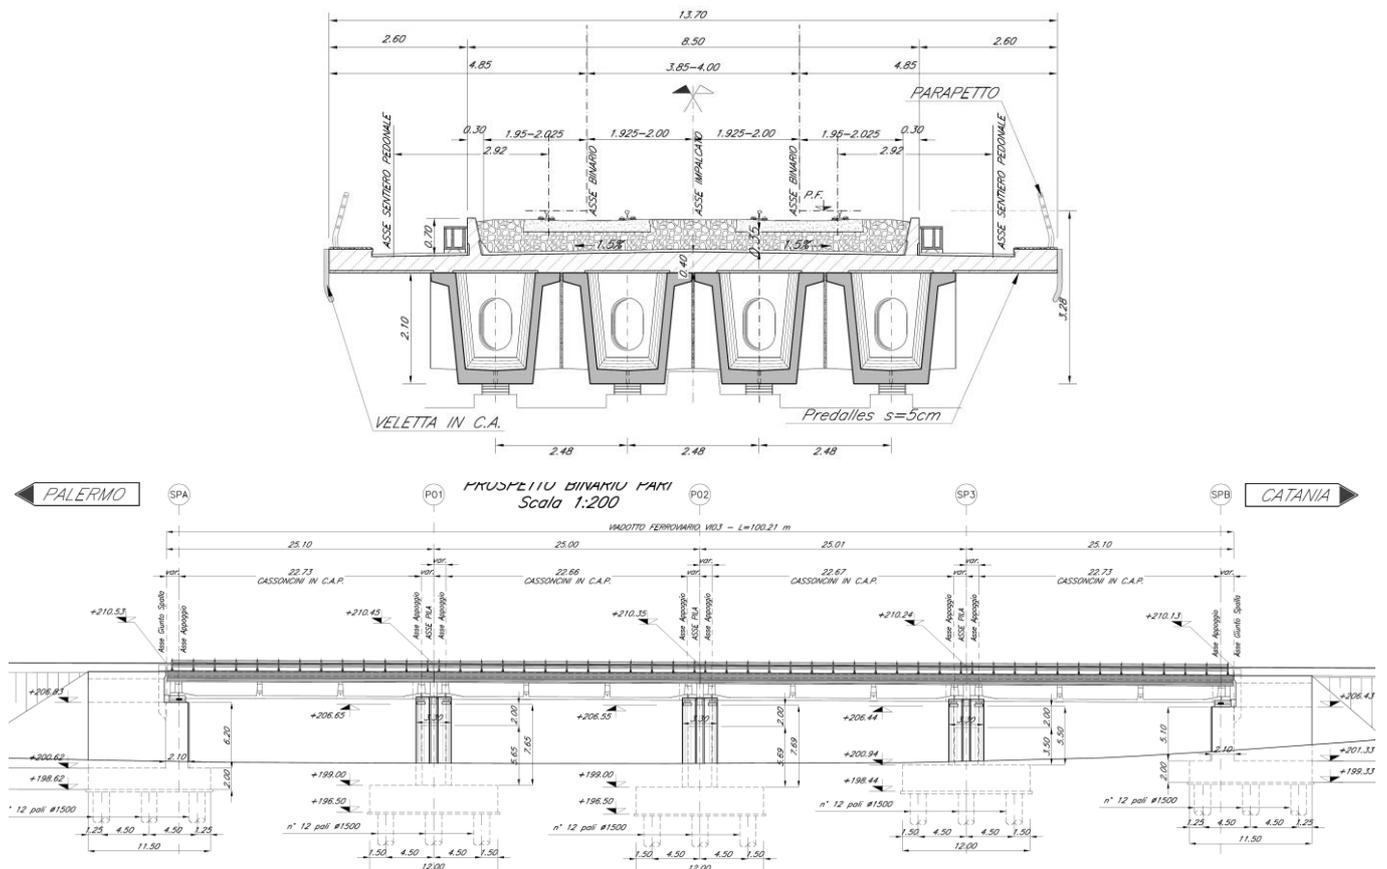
Viadotto VI11: sezione trasversale e prospetto binario pari
